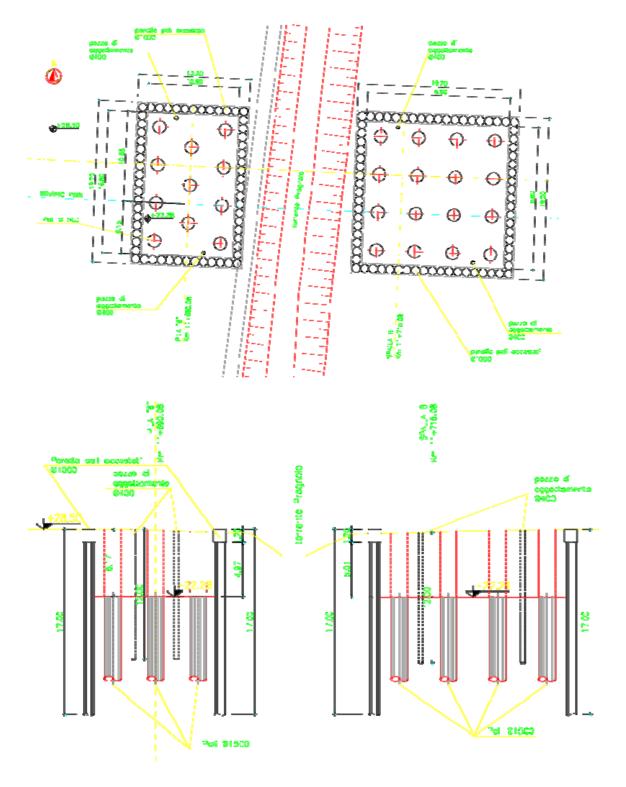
Geometria scavo Pila n.6 e Spalla Est
